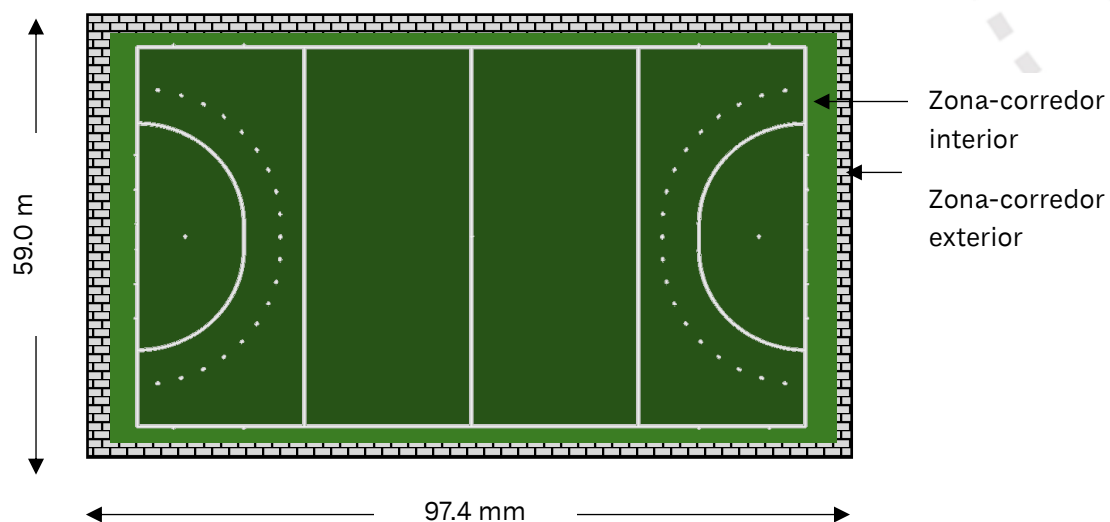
Campo con zonas-corredor mínimas. Zona interior en césped de hockey, zona exterior en pavimento duro.
